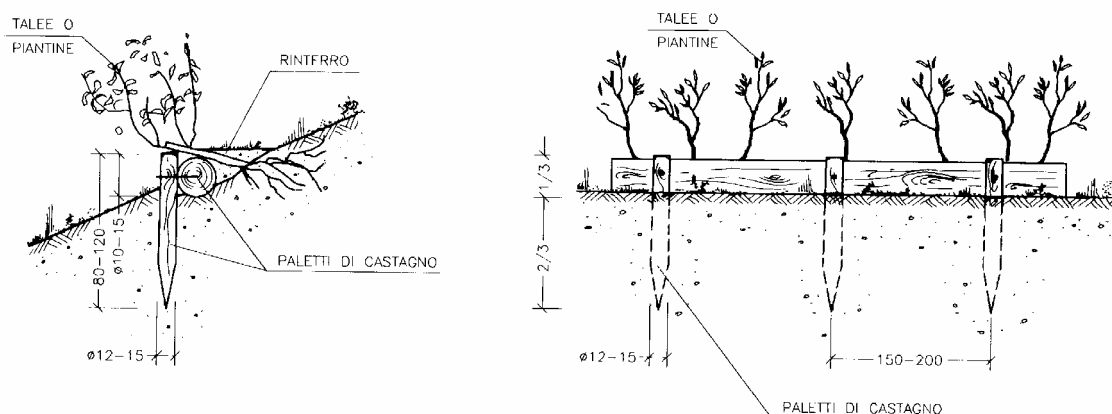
Vista in sezione (a sinistra) e frontale (a destra) di una palizzata con un solo ordine di pali trasversali (da REGIONE LIGURIA, 1997) -
